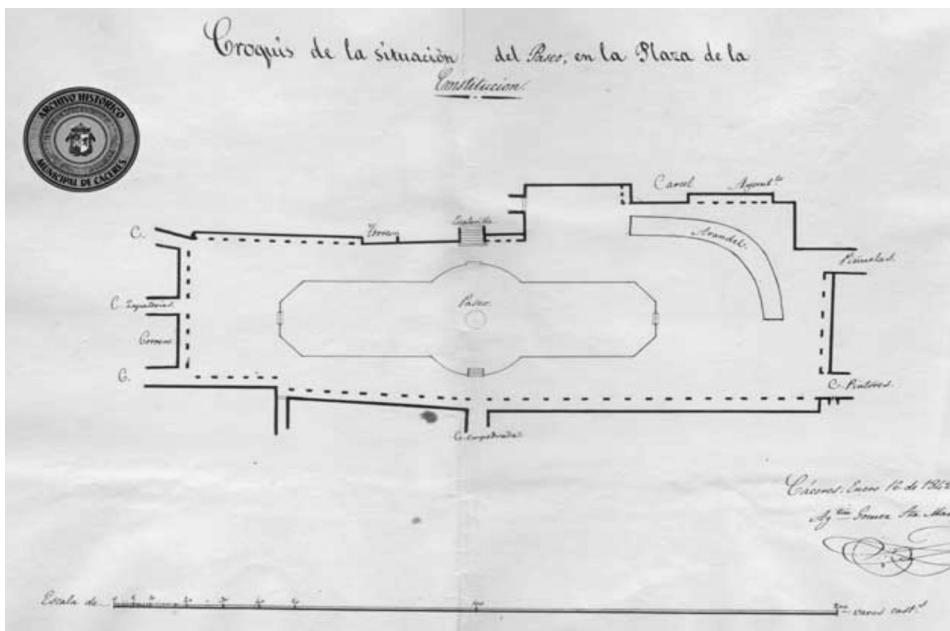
Proyecto de reforma de la bandeja de la Plaza Mayor, firmado por Gómez de Santa María en 1842. En él se aprecia la fachada del Ayuntamiento y la cárcel (A.H.M.C.).
